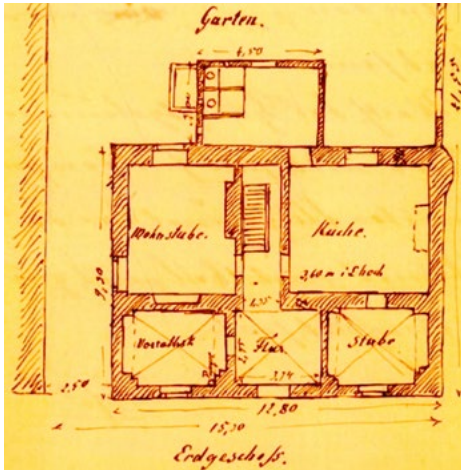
Arresthaus in Moers, Erdgeschoss-Grundriss
